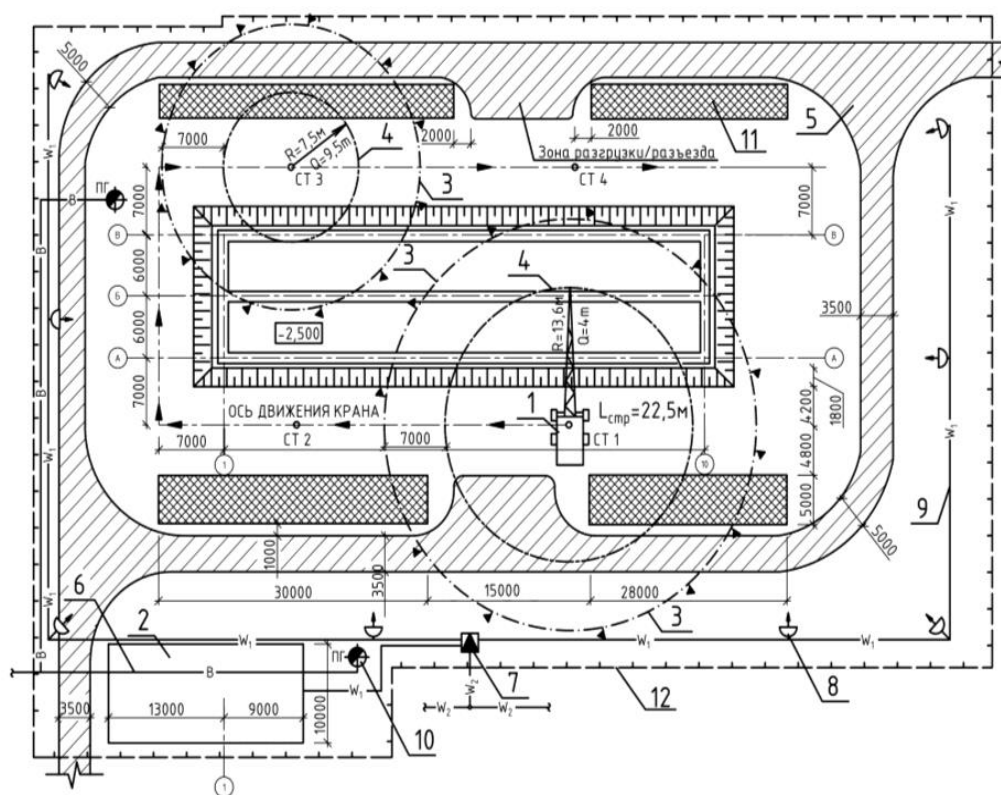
Строительный генеральный план на возведение подземной части здания: 1 – самоходный кран; 2 – место расположения бытового городка; 3 – граница опасной зоны; 4 – граница монтажной зоны; 5 – временная дорога; 6 – временный водопровод; 7 – временная трансформаторная подстанция; 8 – проекторная мачта или вышка; 9 – временная воздушная ЛЭП; 10 – пожарный гидрант; 11 – зона складирования материалов и конструкций; 12 – ограждение строительной площадки
